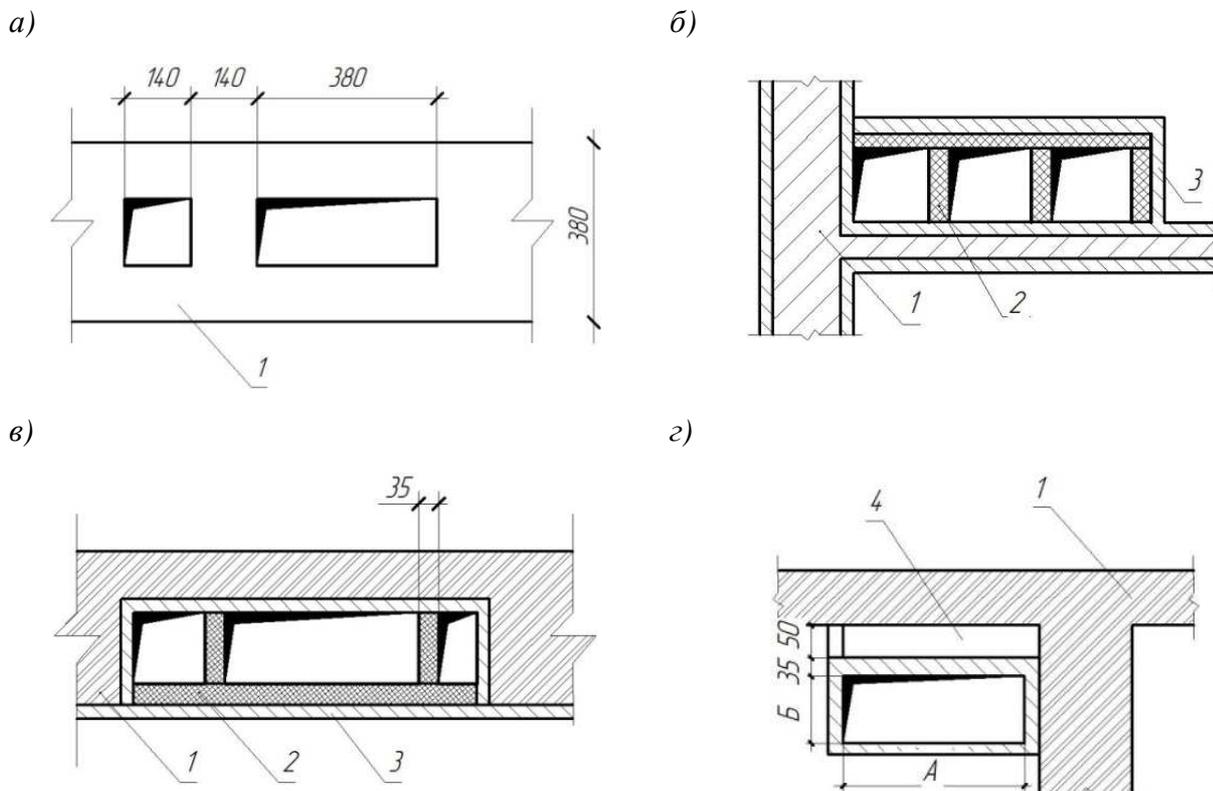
Варианты исполнения вентиляционных каналов: *а* – в кирпичной стене; *б* – приставные (пристенные) вертикальные каналы; *в* – в борозде стены, закрытые плитой; *з* – канал приставной у наружной стены; *1* – кирпичная стена; *2* – шлакогипсовая плита; *3* – штукатурка; *4* – герметичная воздушная прослойка (или слой утеплителя).
